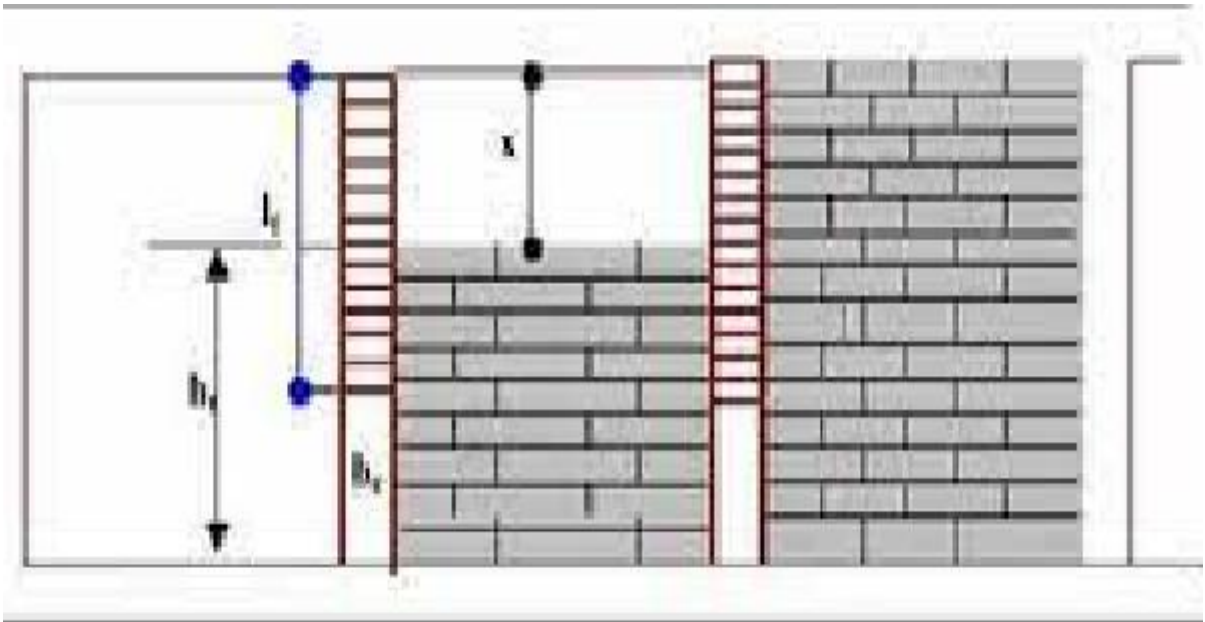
Cas de constitution de poteau court par hauteur insuffisante de la
